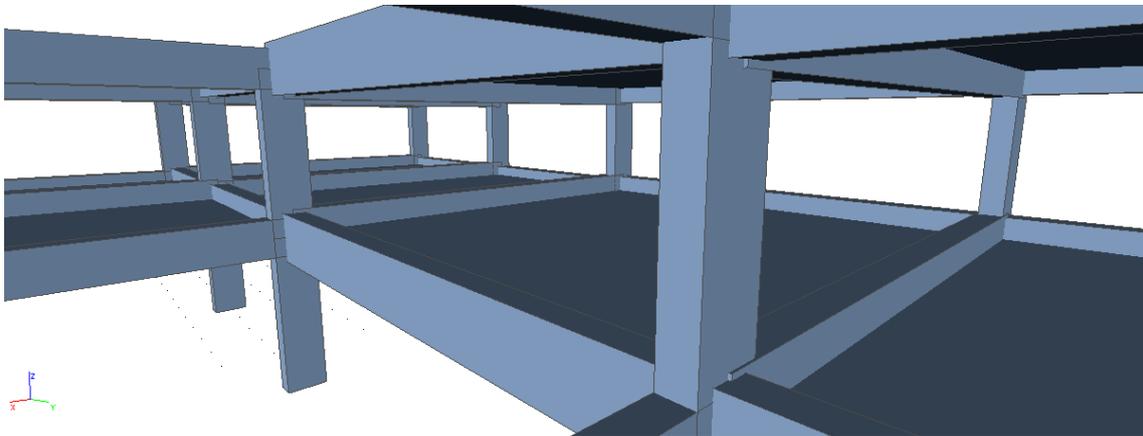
Estrutura de concreto – Detalhe dimensão das vigas e pilares
